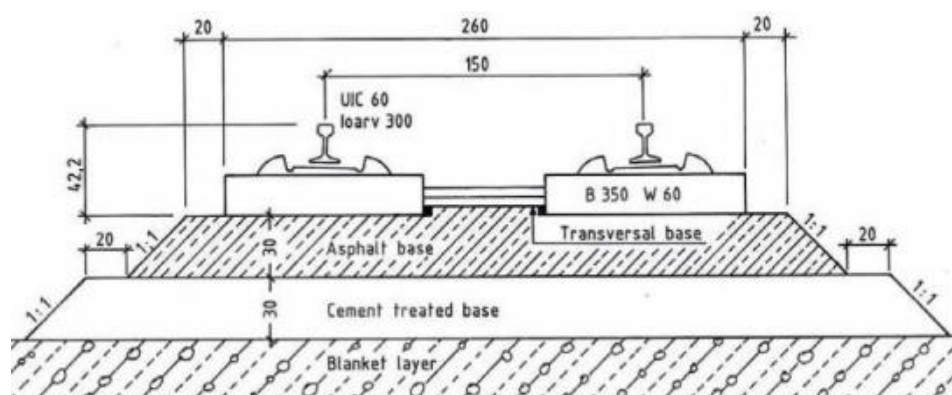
Perfil transversal esquemático da solução ATD com travessa bi-bloco (Lechner, 2005)
